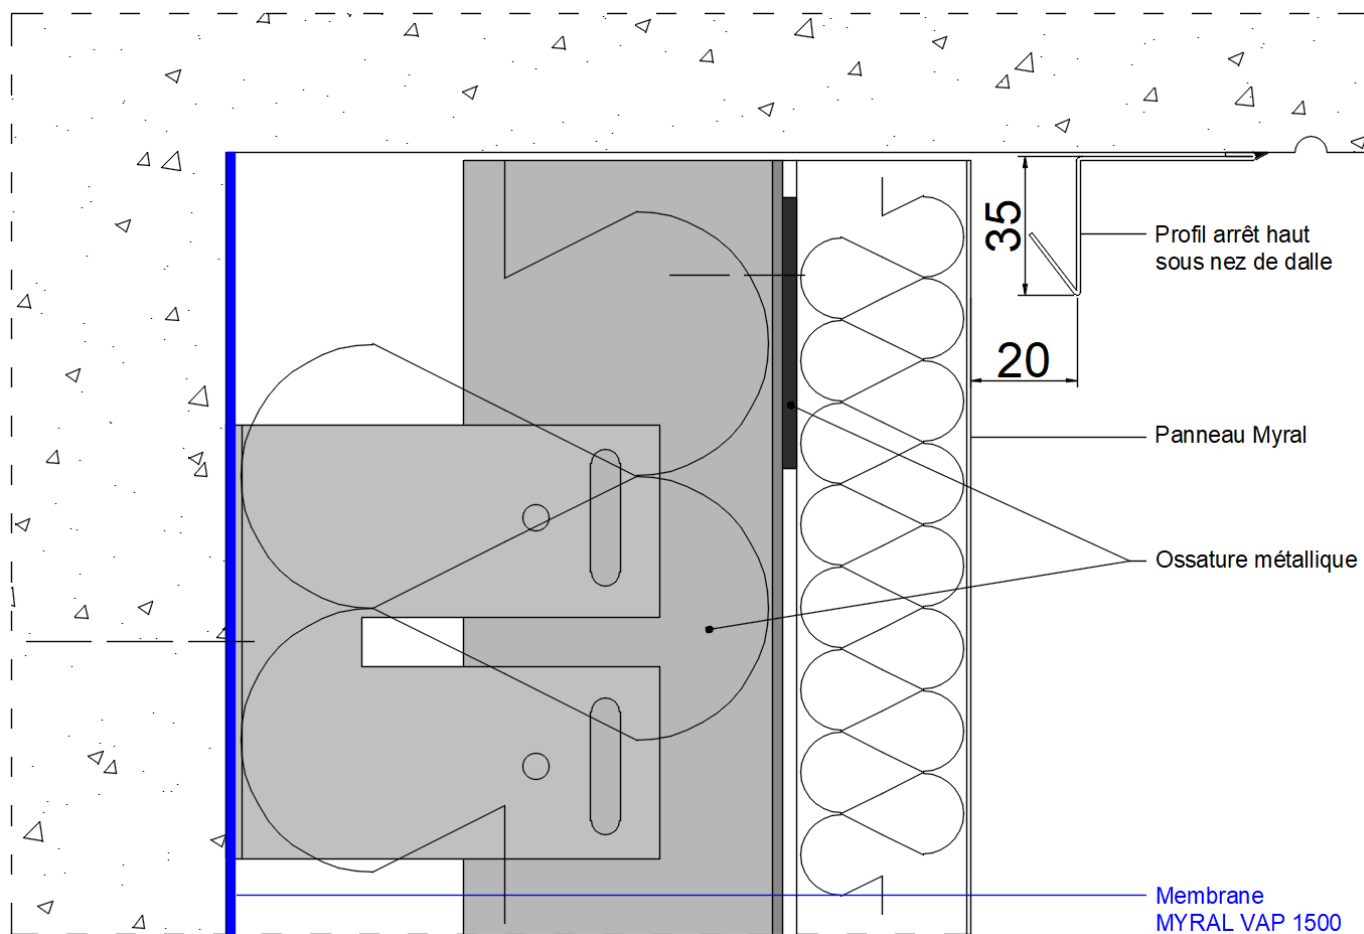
Haut de façade avec nez de dalle saillant - Coupe verticale
